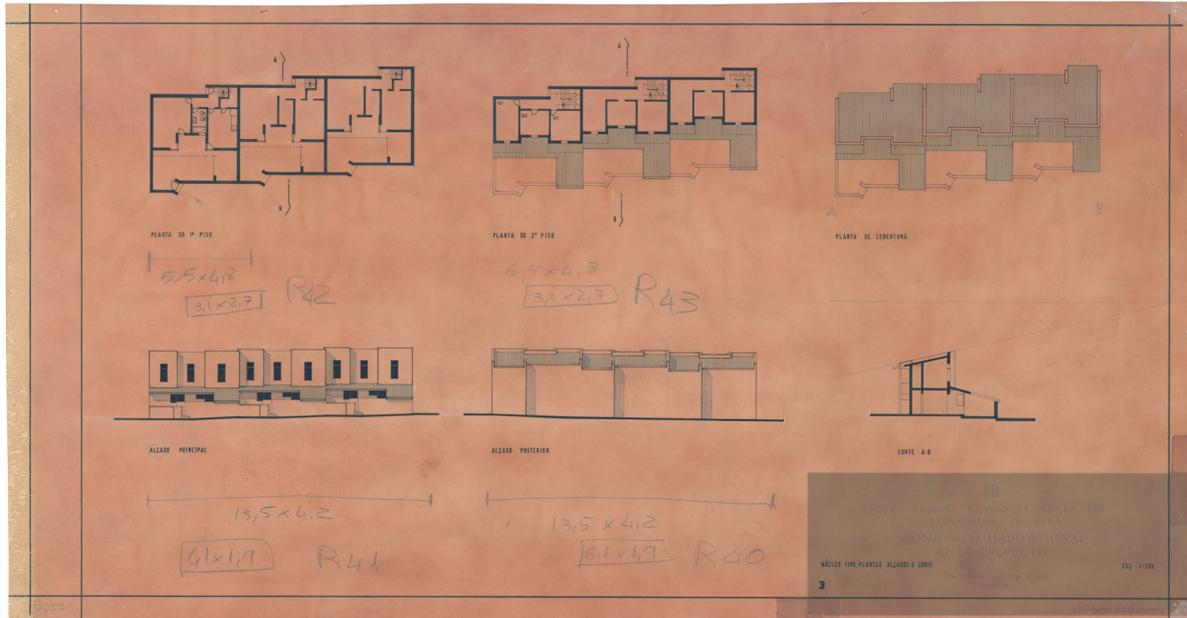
Anteprojeto: Núcleo tipo – plantas, alçados e cortes
